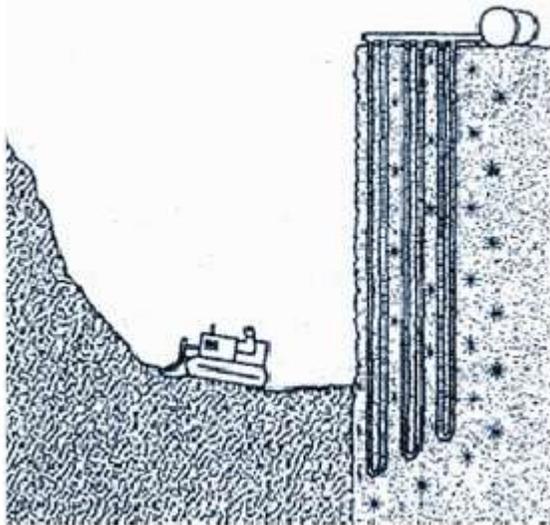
FIGURA: Representación gráfica del apuntalamiento congelado de un corte vertical de terreno, que permite el tránsito seguro de maquinaria y trabajadores en el fondo de la excavación.
